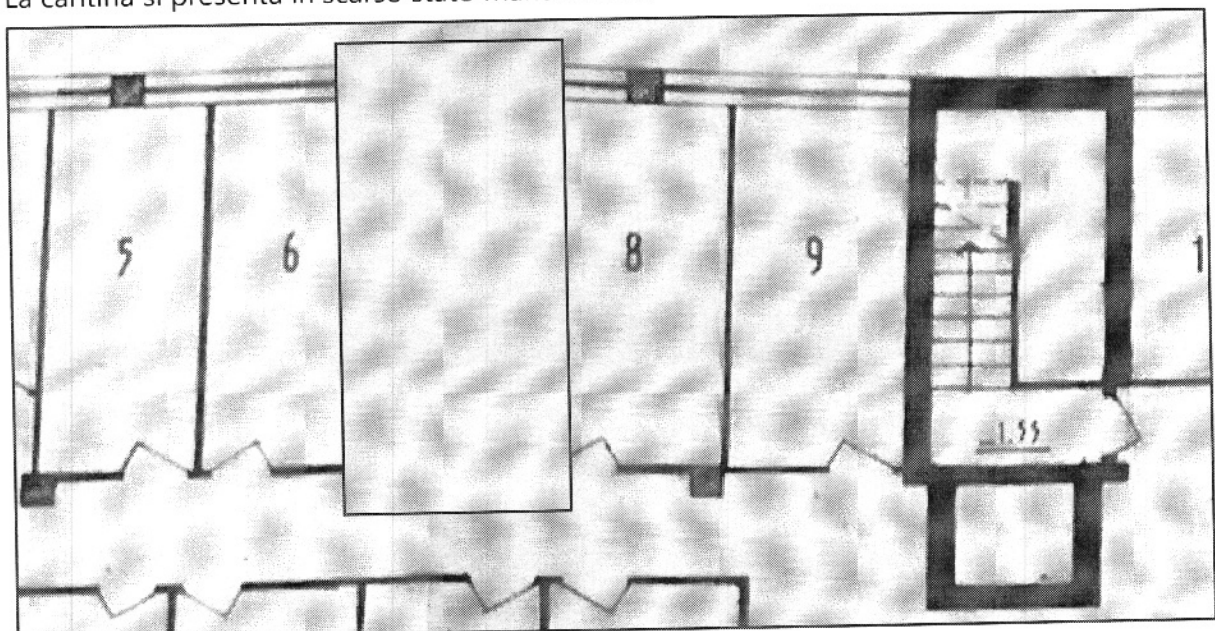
Estratto planimetria piano cantinato - Licenza di Costruire 6982
